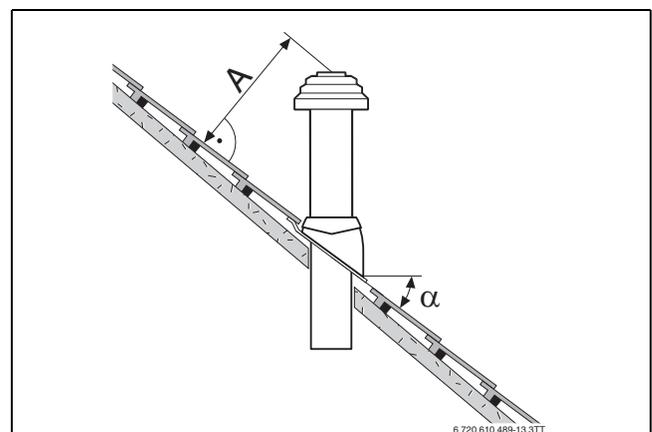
Abstandsmaße und Dachneigungen bei Schrägdach
